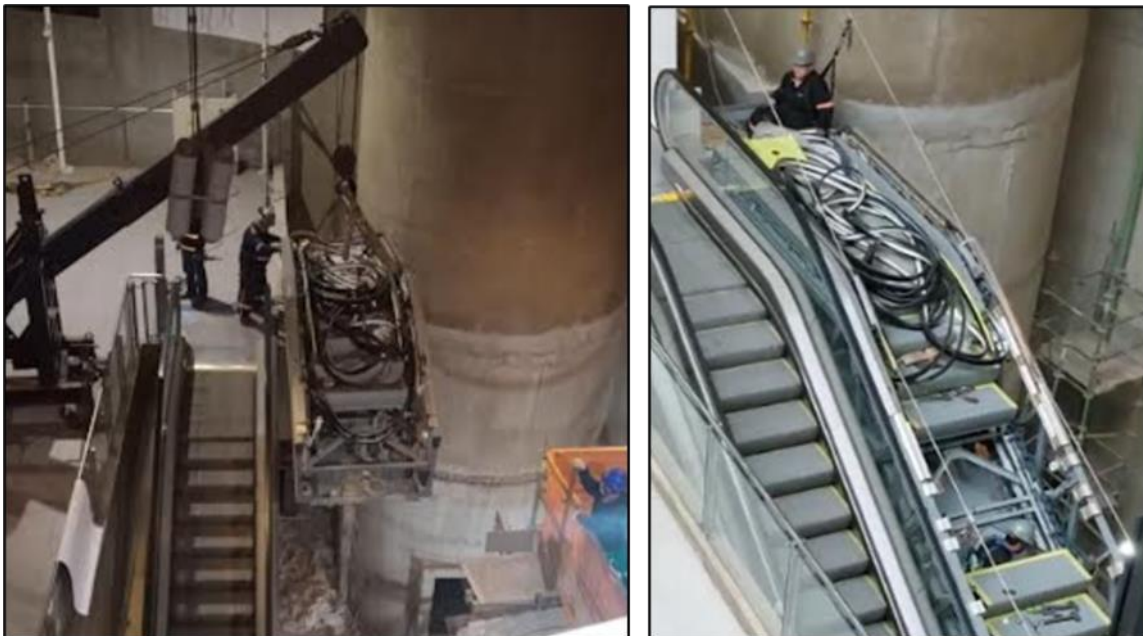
Sprints 3 e 4 – posicionamento e montagem da escada rolante
